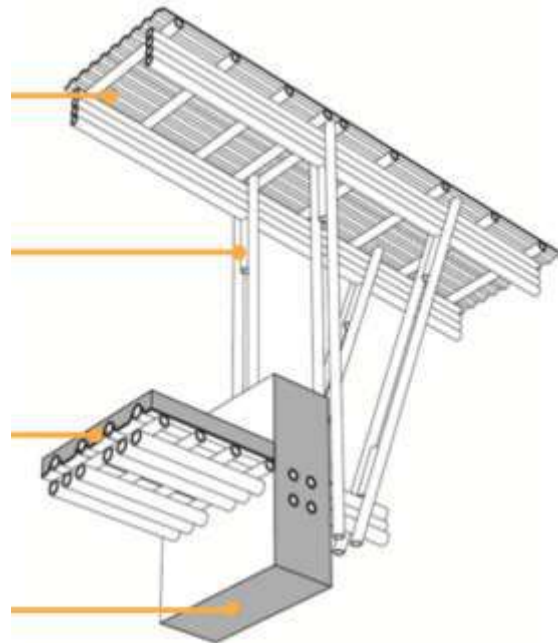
Estructura de cubierta, Escuela Meti. Fuente: Elaboración propia con base a Anna Heringer Architecture.
